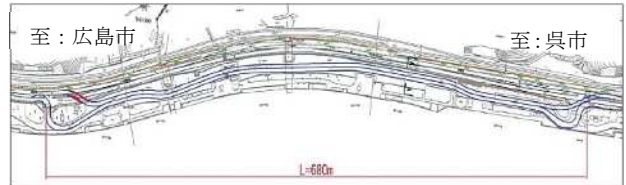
国道 31 号 坂町水尻 仮設迂回路計画平面図¹⁾
